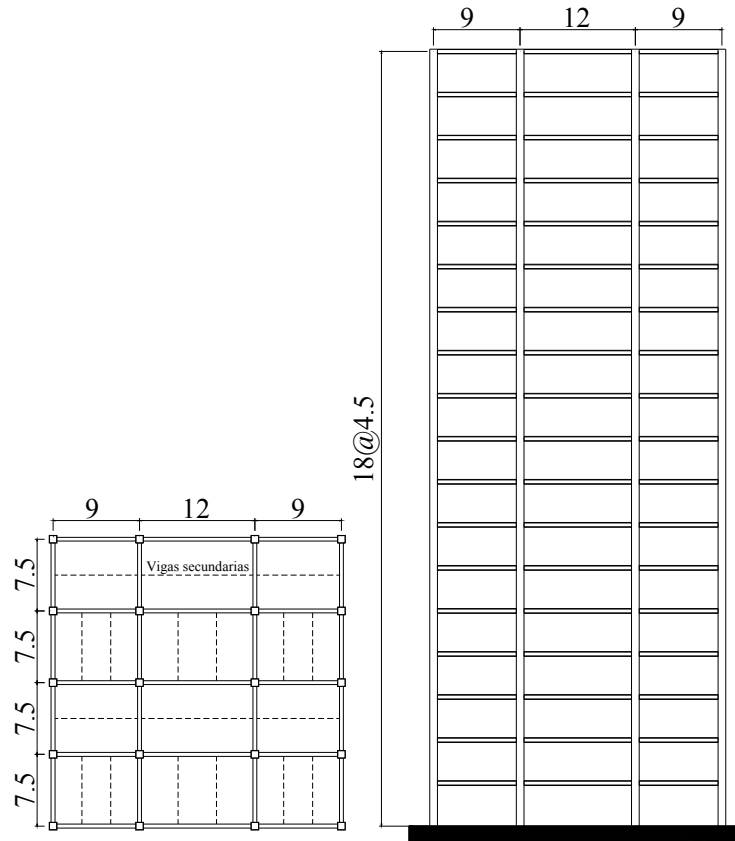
Vista en planta y elevación de la estructura de 18 niveles (dimensiones en metros)
